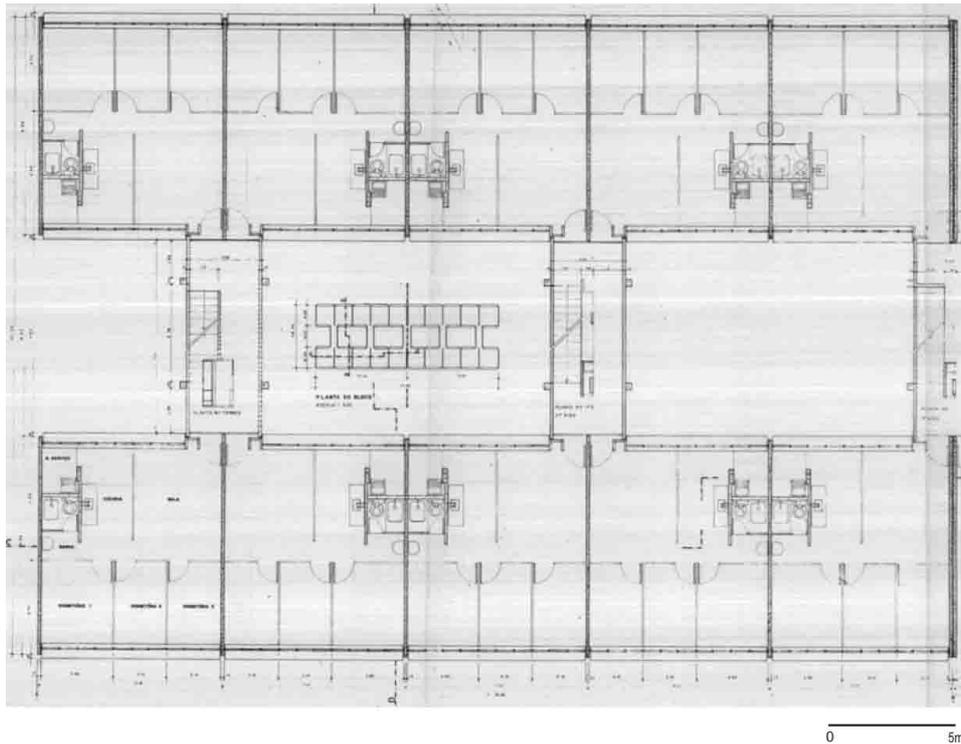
Planta del piso tipo 2ª etapa (Fuente: <sup>8</sup>)
